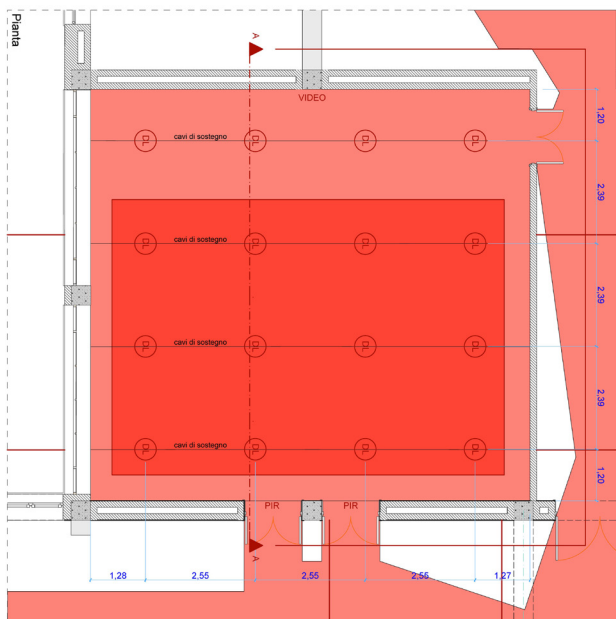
Laboratorio sperimentale aula 2.8. Vista planimetrica.
